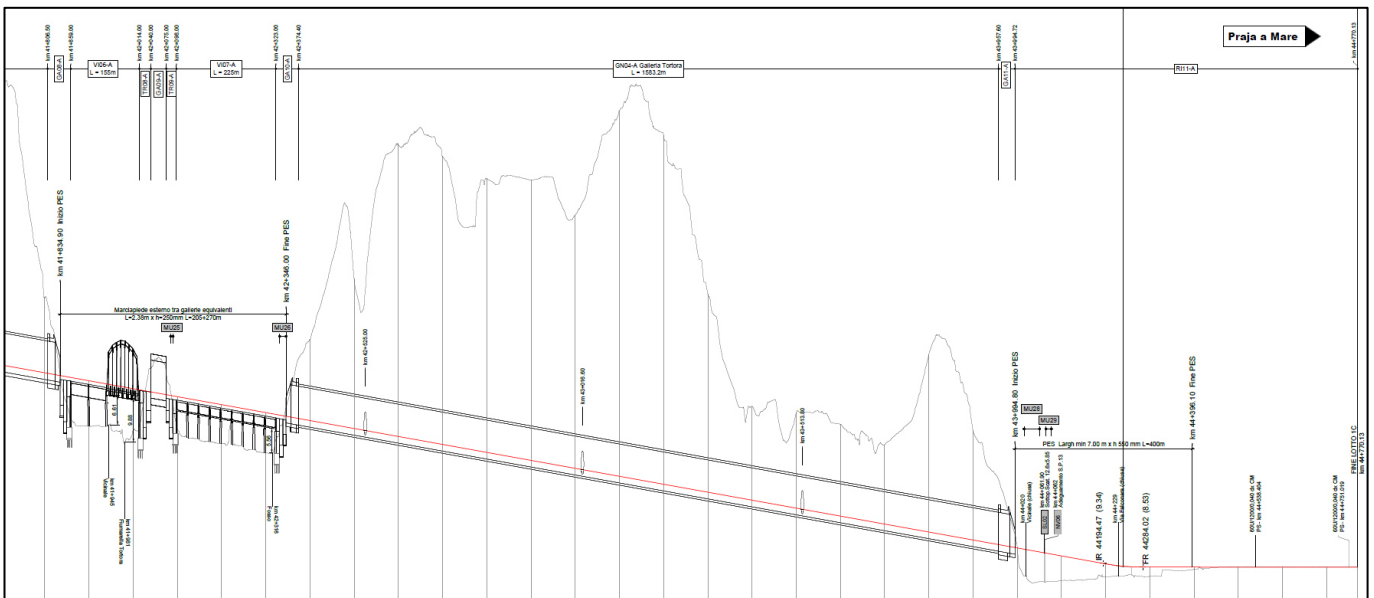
Profilo di progetto VI05 da km 41+859 al km 44+770 BP
